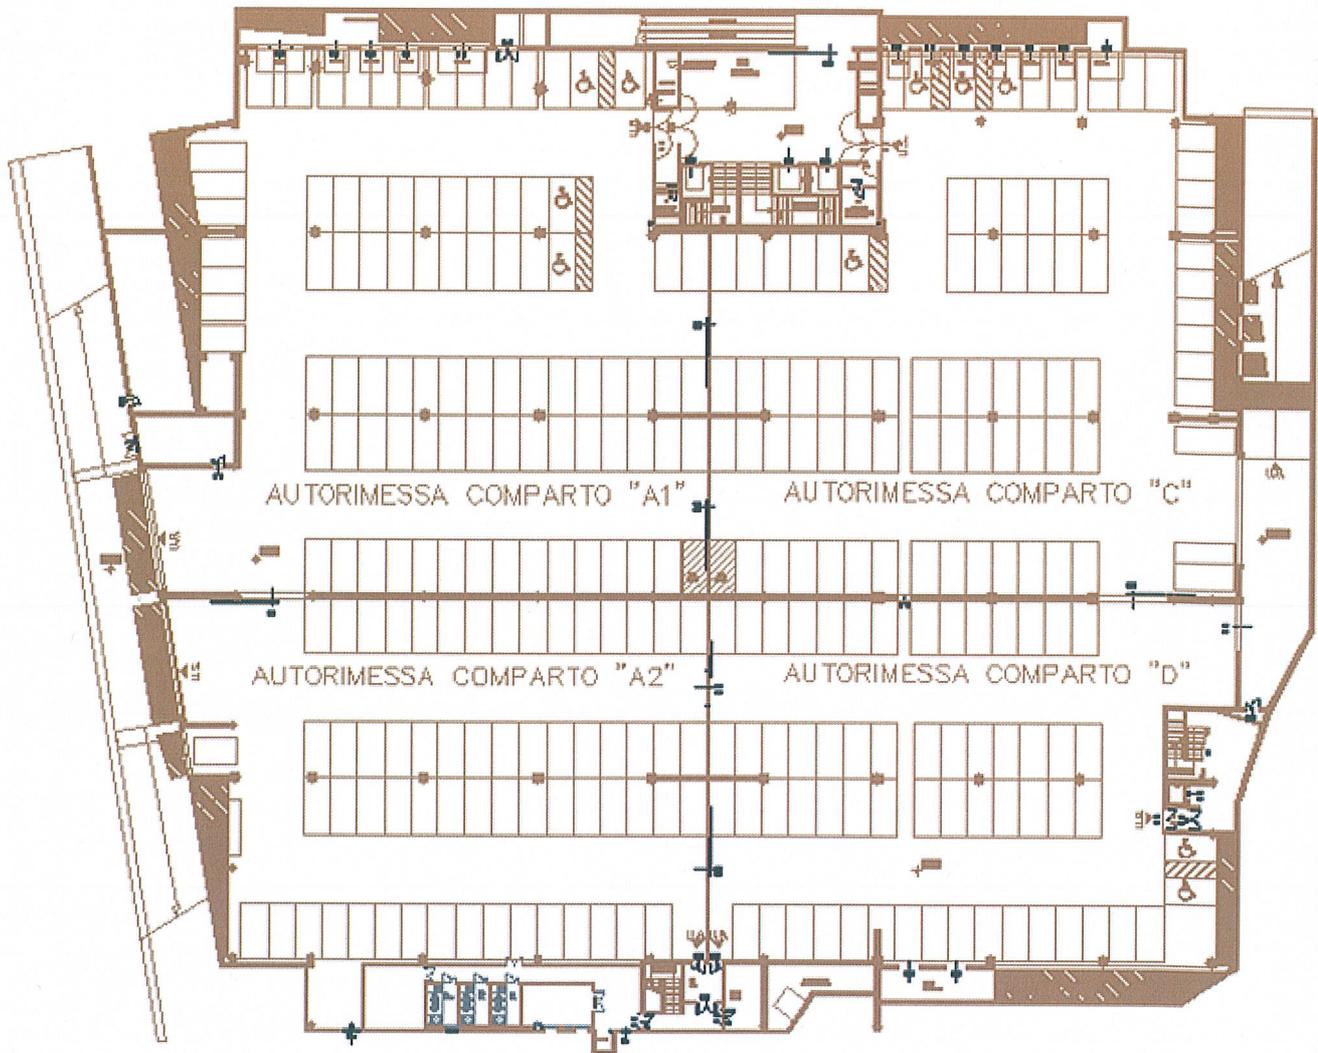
Planimetria dell'attività da progetto – piano interrato
